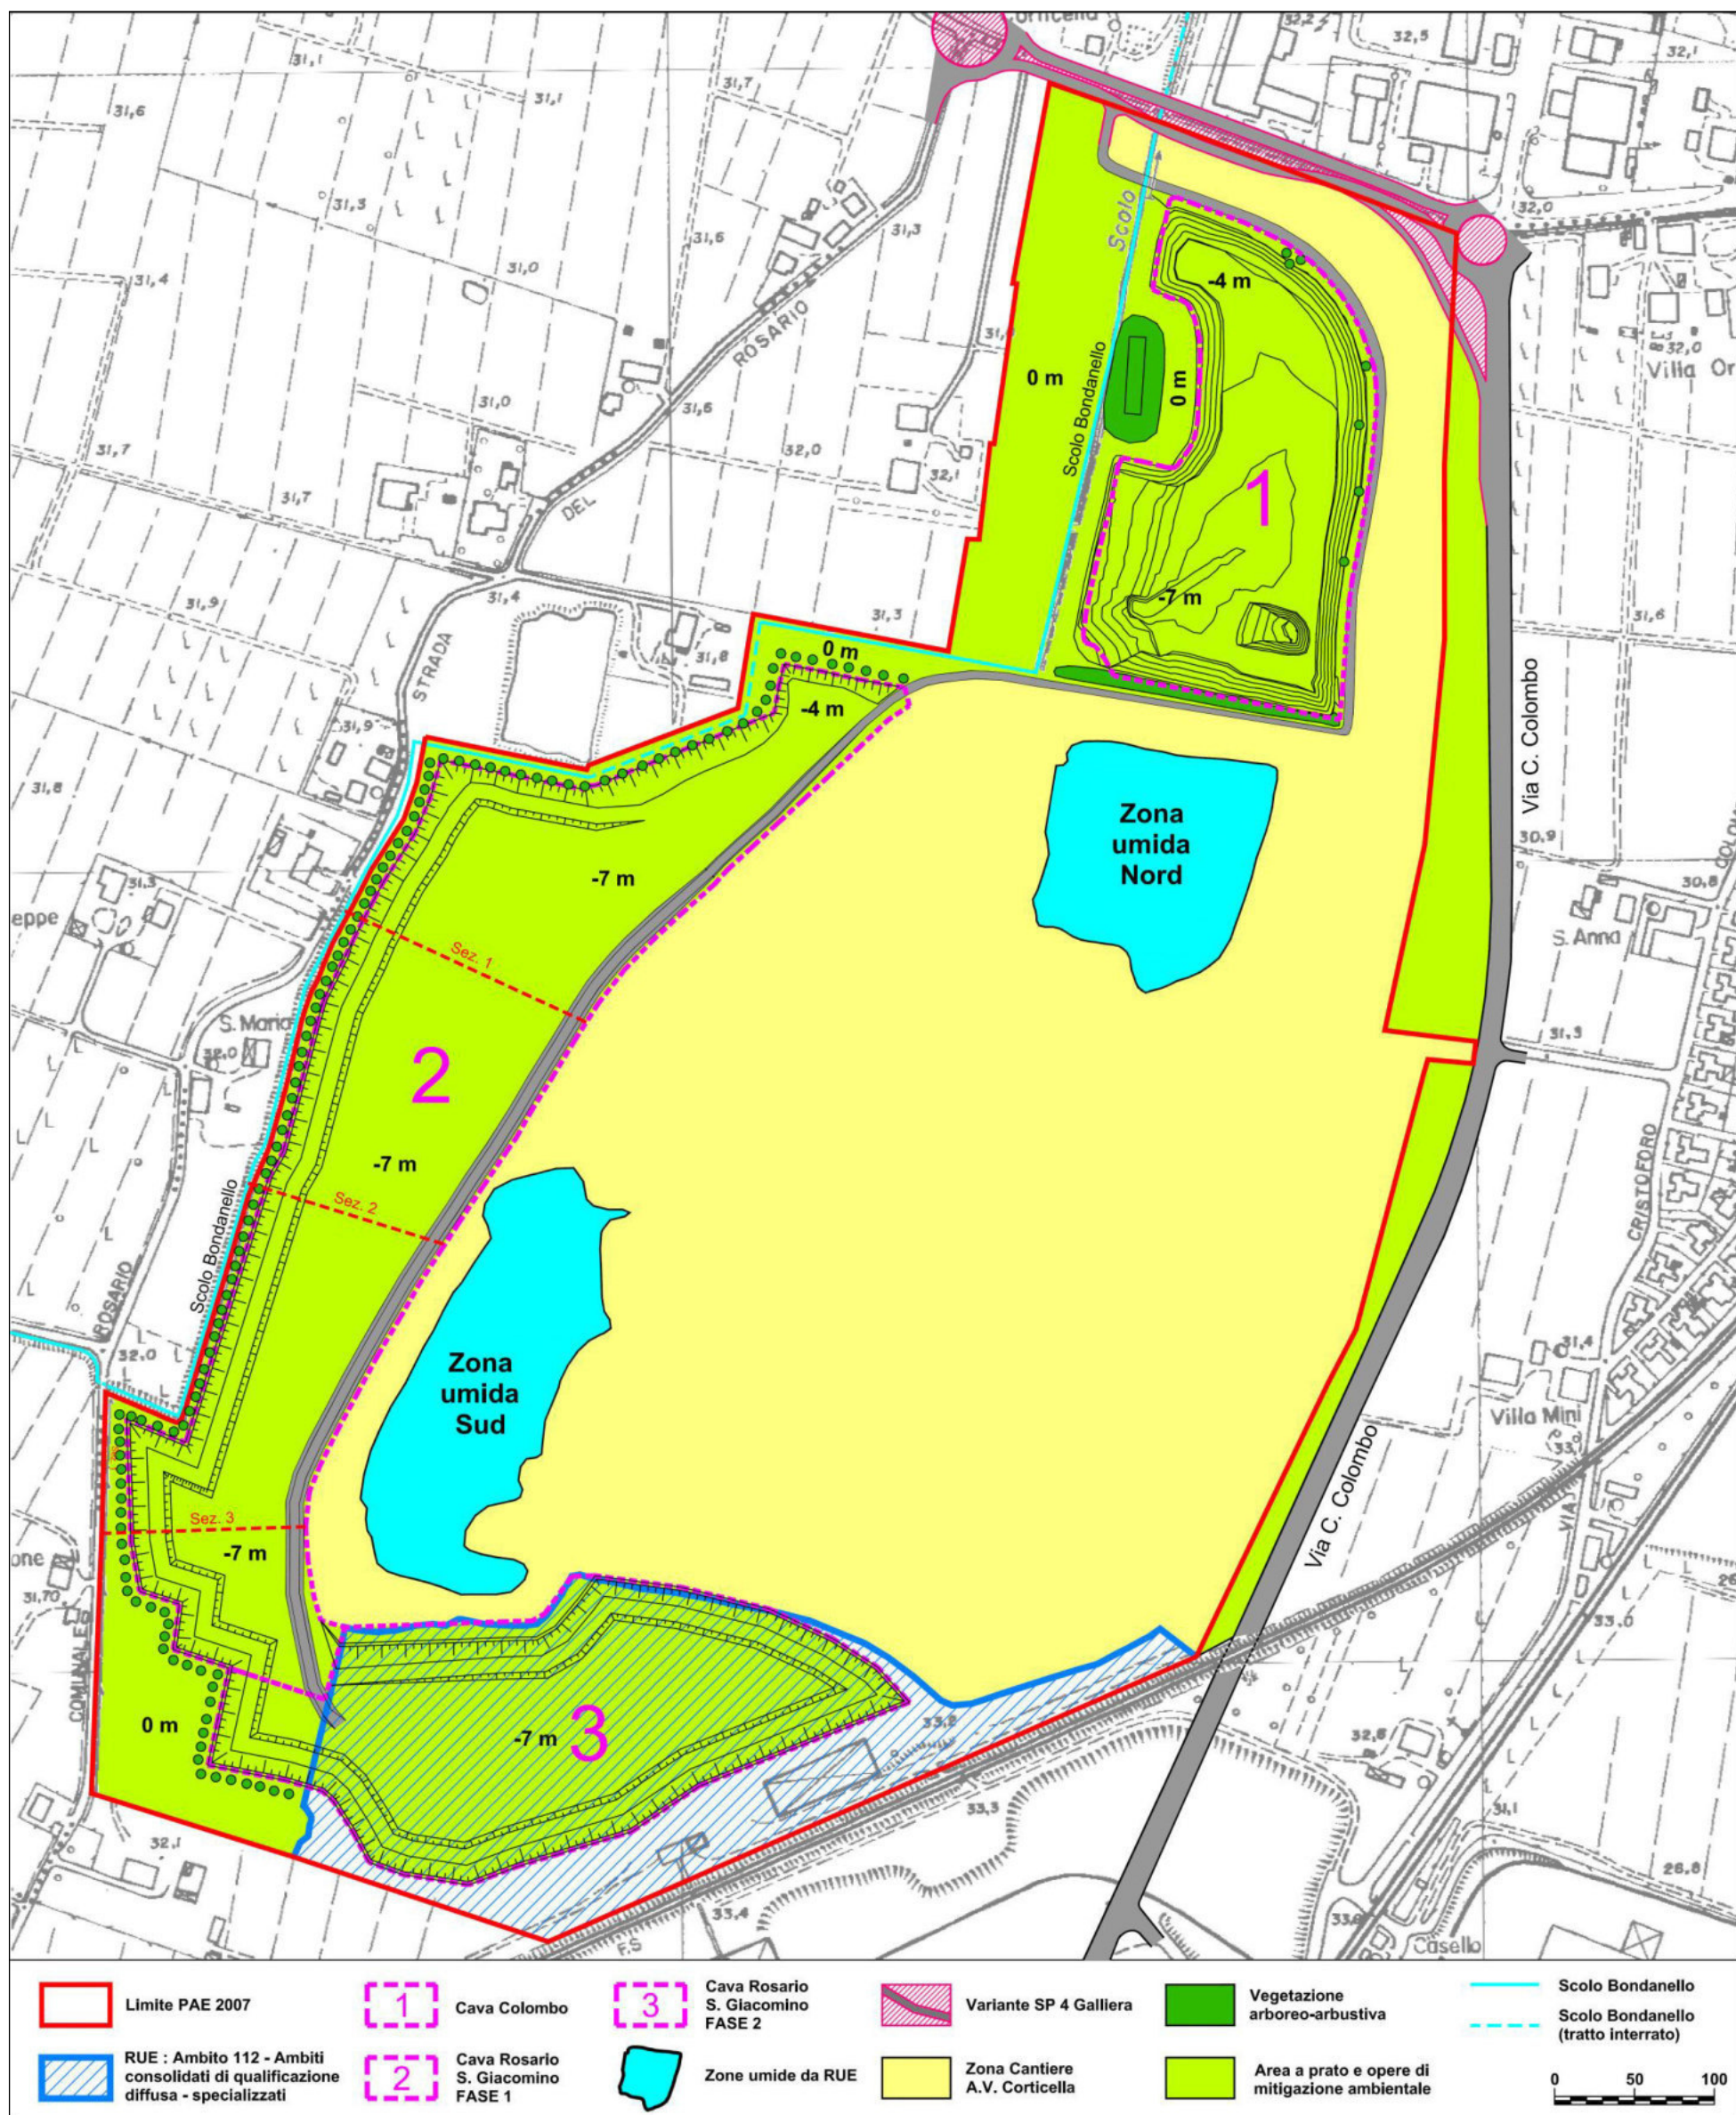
Planimetria del progetto di massima degli interventi di sistemazione
